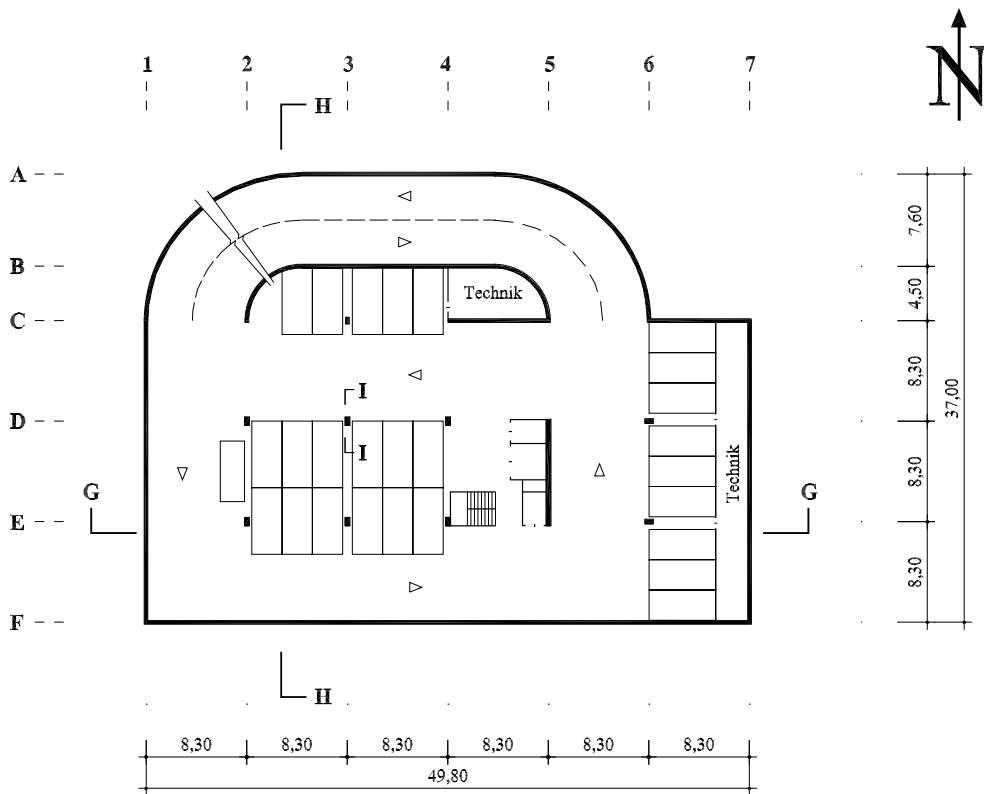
Grundriss 1. UG (Abmessungen in m)
